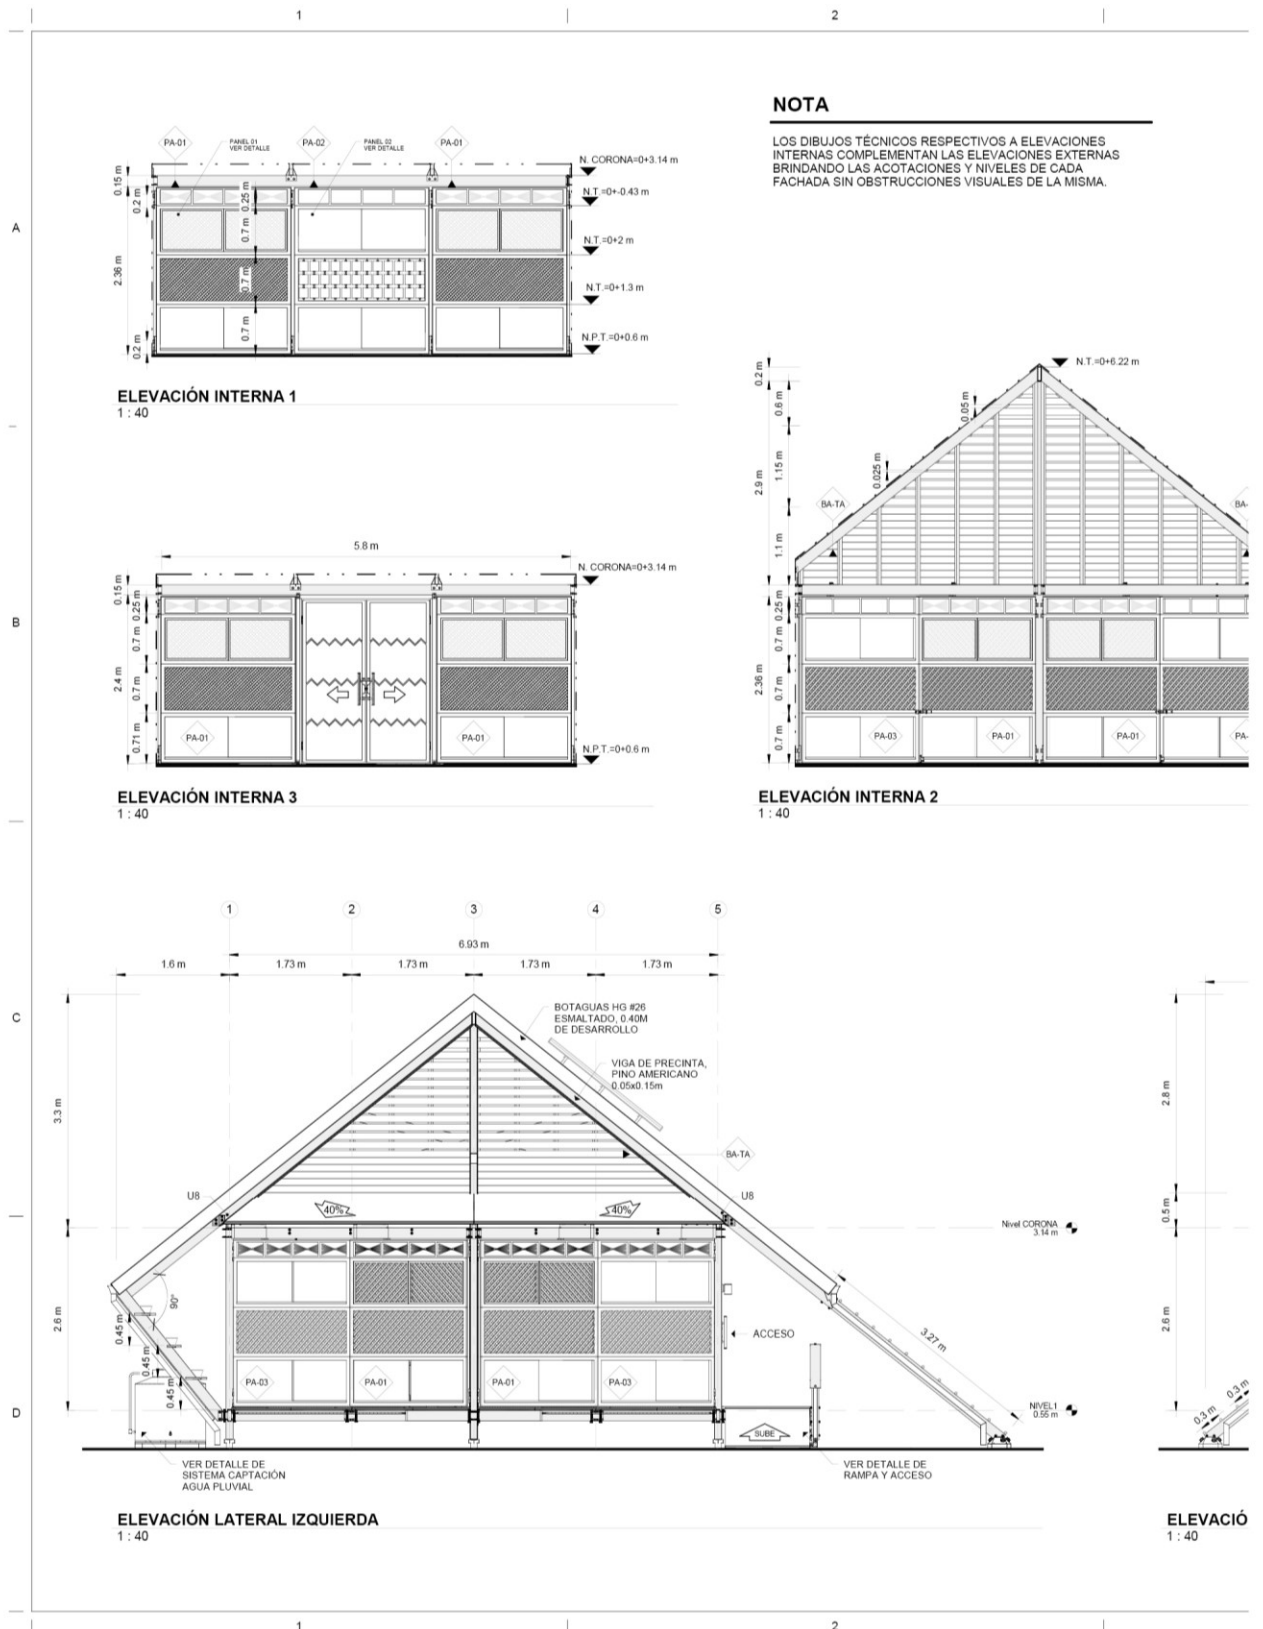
Lámina 08, planimetría de tipología B.<sup>317</sup>
